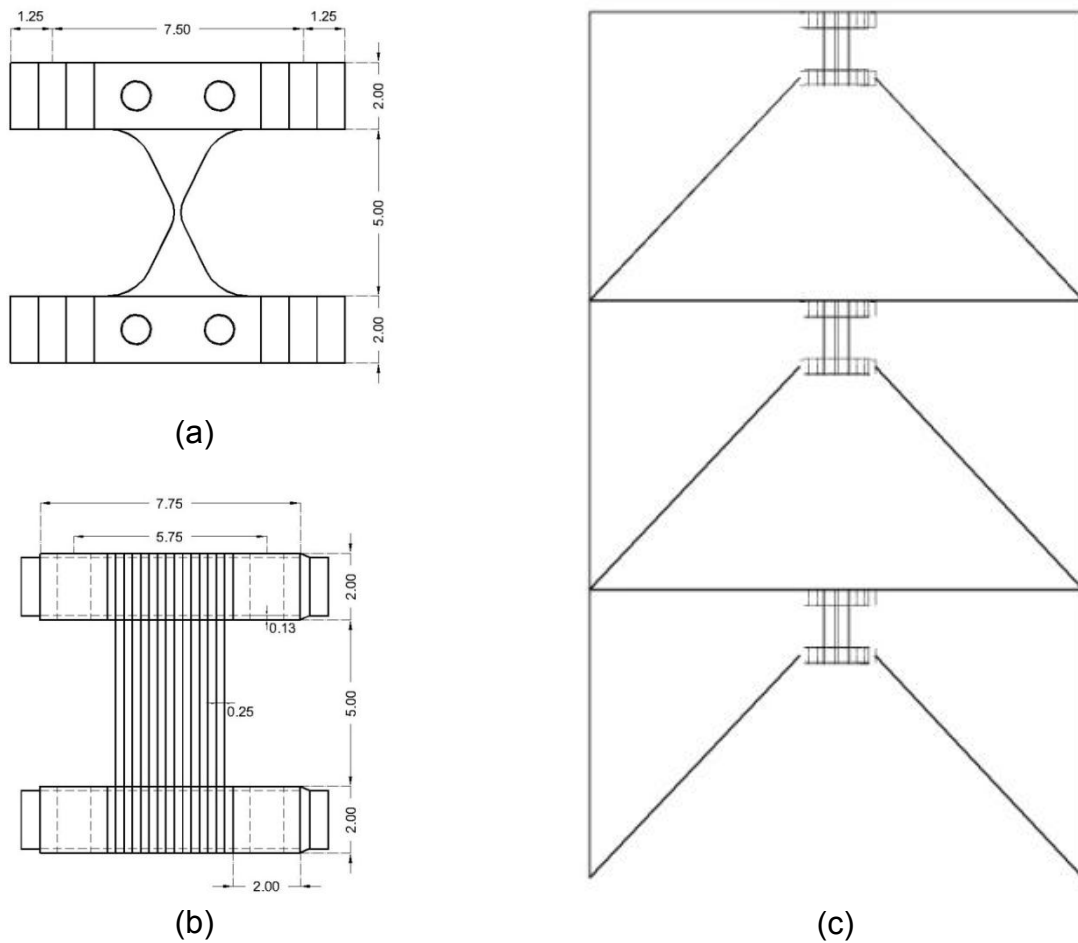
Sistema ADAS desarrollado por Scholl (1993). (a) Dimensiones. (b) Conexión típica con planchas en paralelo. (c) Ubicación de la conexión en un marco.
